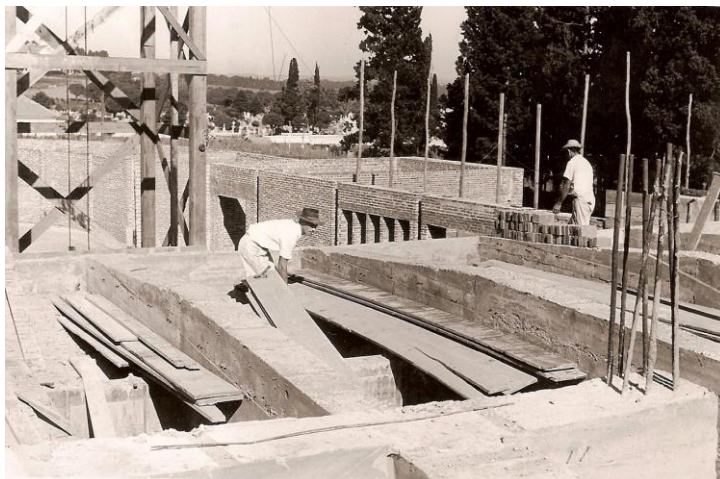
Construção da igreja em andamento no ano de 1960.
